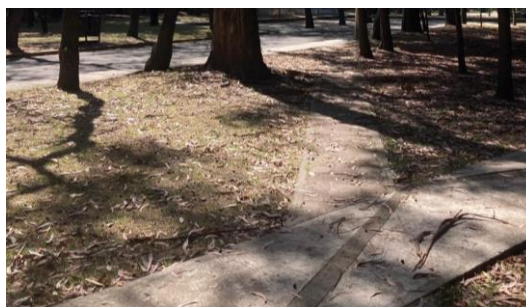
Pavimentos de la zona de meditación. Fuente: Elaboración propia.
